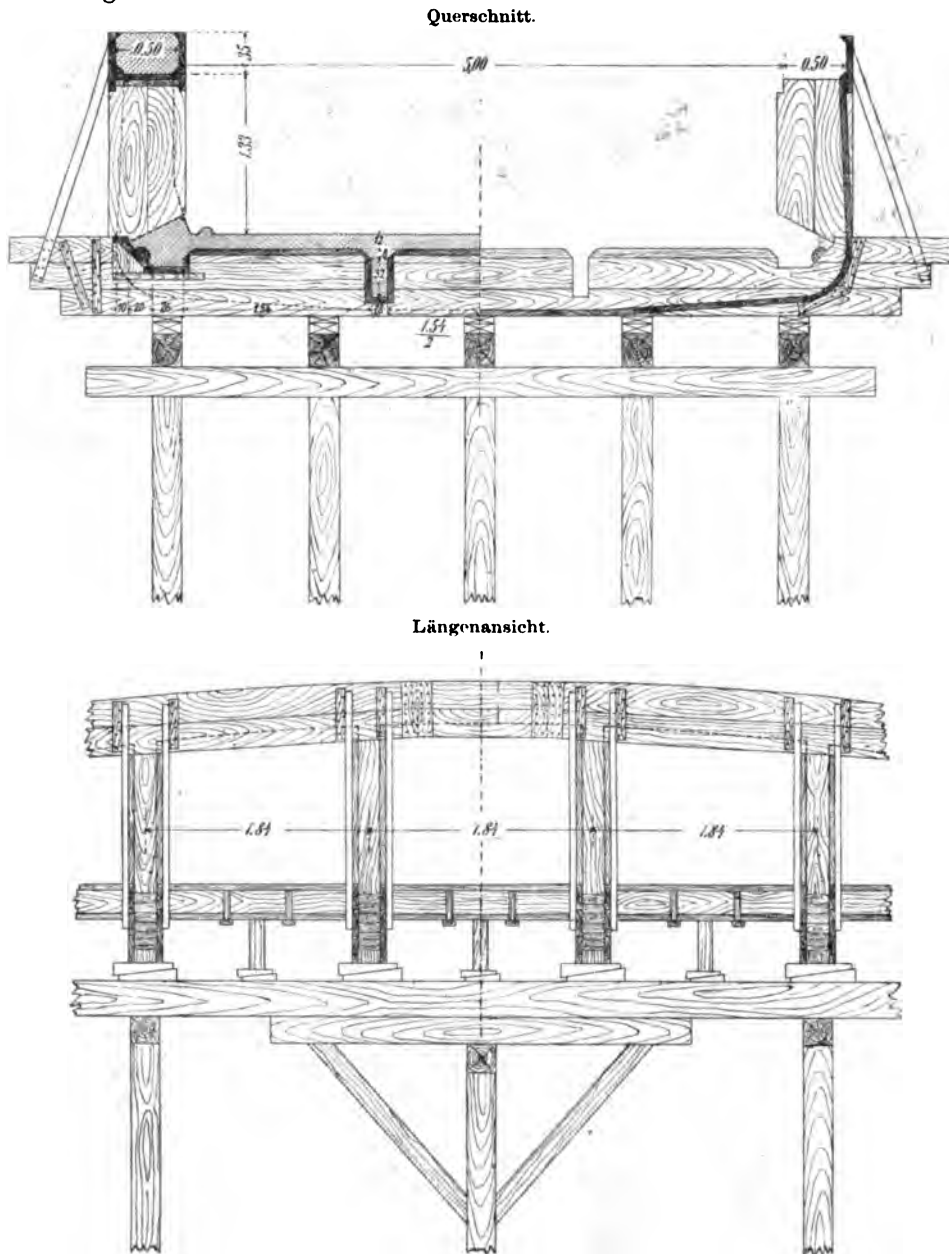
Einrüstung der Straßenbrücke über die Seille bei Pettoncourt.
